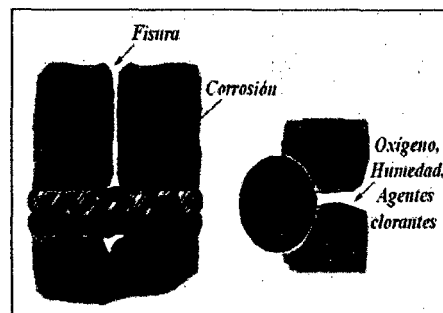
13. Influencia de las fisuras en la corrosión. Fuente: (Stuardo P., 2008)
